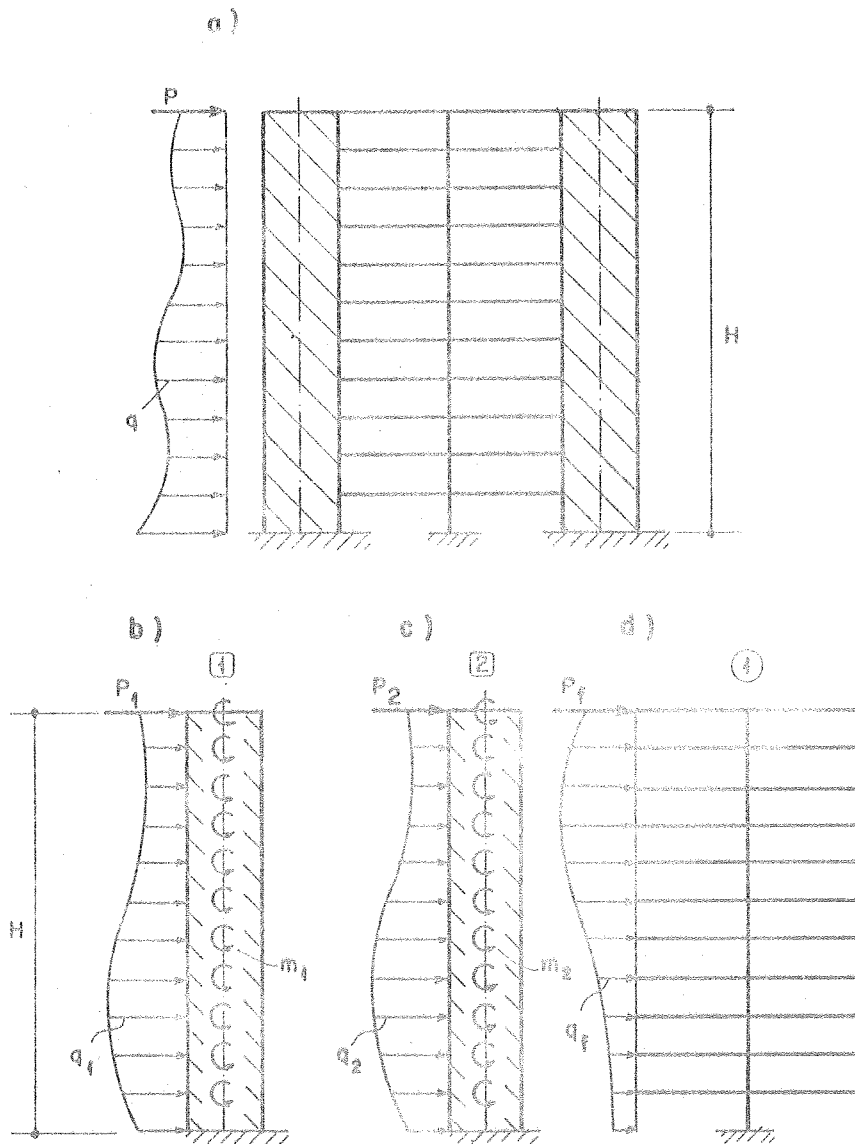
PILAR DE PÓRTICO LIGADO A DUAS PAREDES
